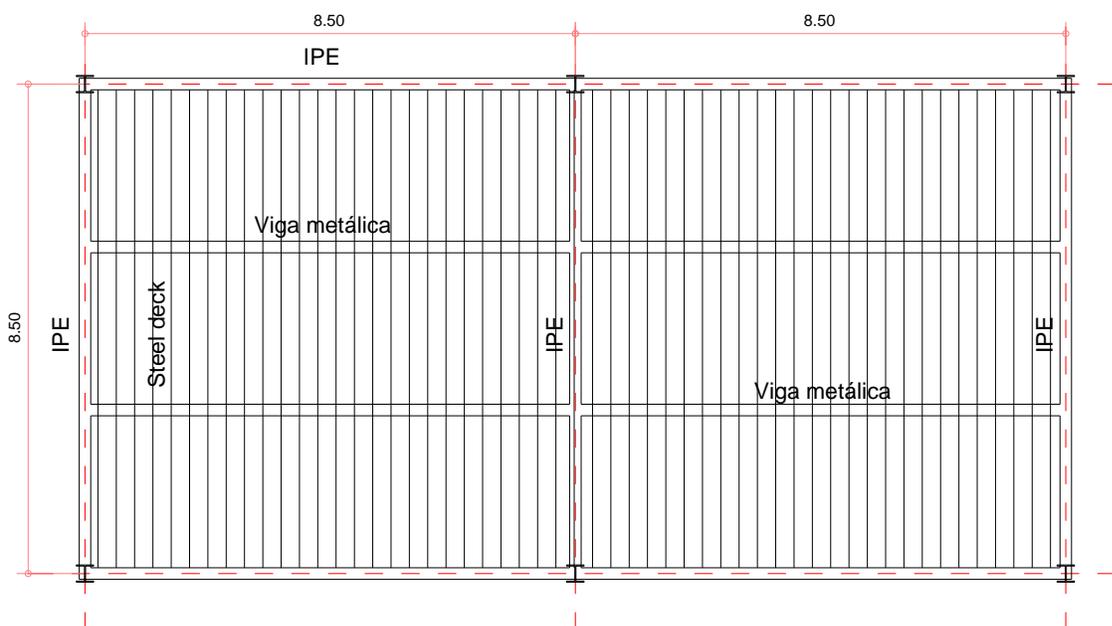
Esquema estructura en pórticos de acero y losa en una dirección conformada por viguetas metálicas y lámina colaborante.
